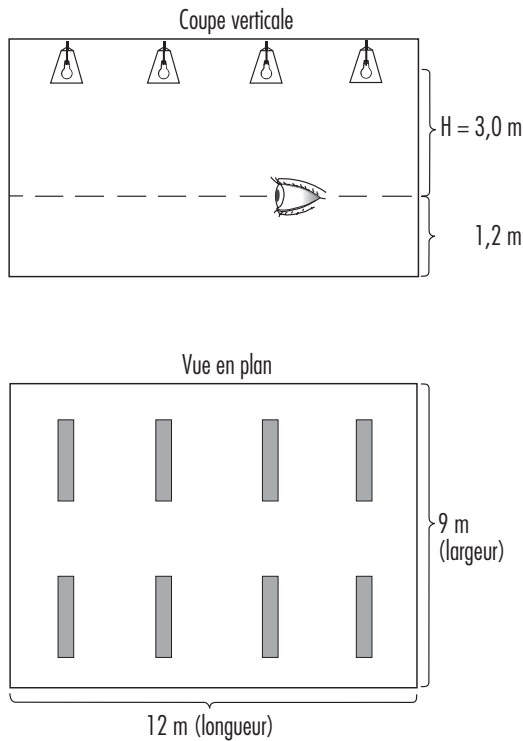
• Coupe verticale et vue en plan d'un local type
